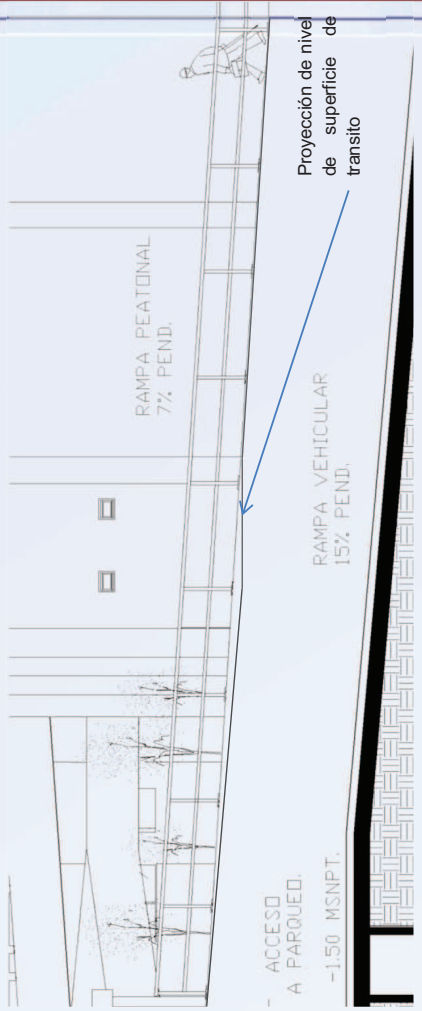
Rampa de circulación peatonal en ingreso Este. Escala.: 1:100.
